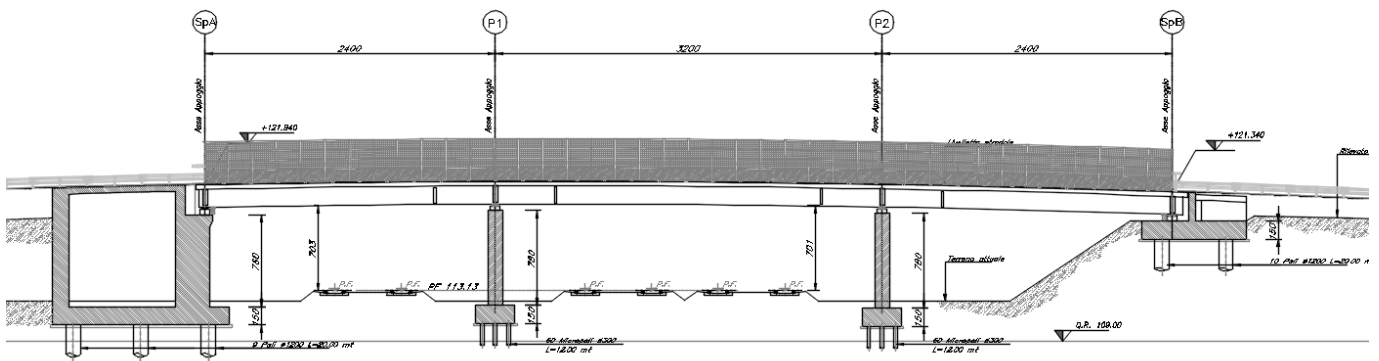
Sezione longitudinale nuovo cavalcavia S.R.10
